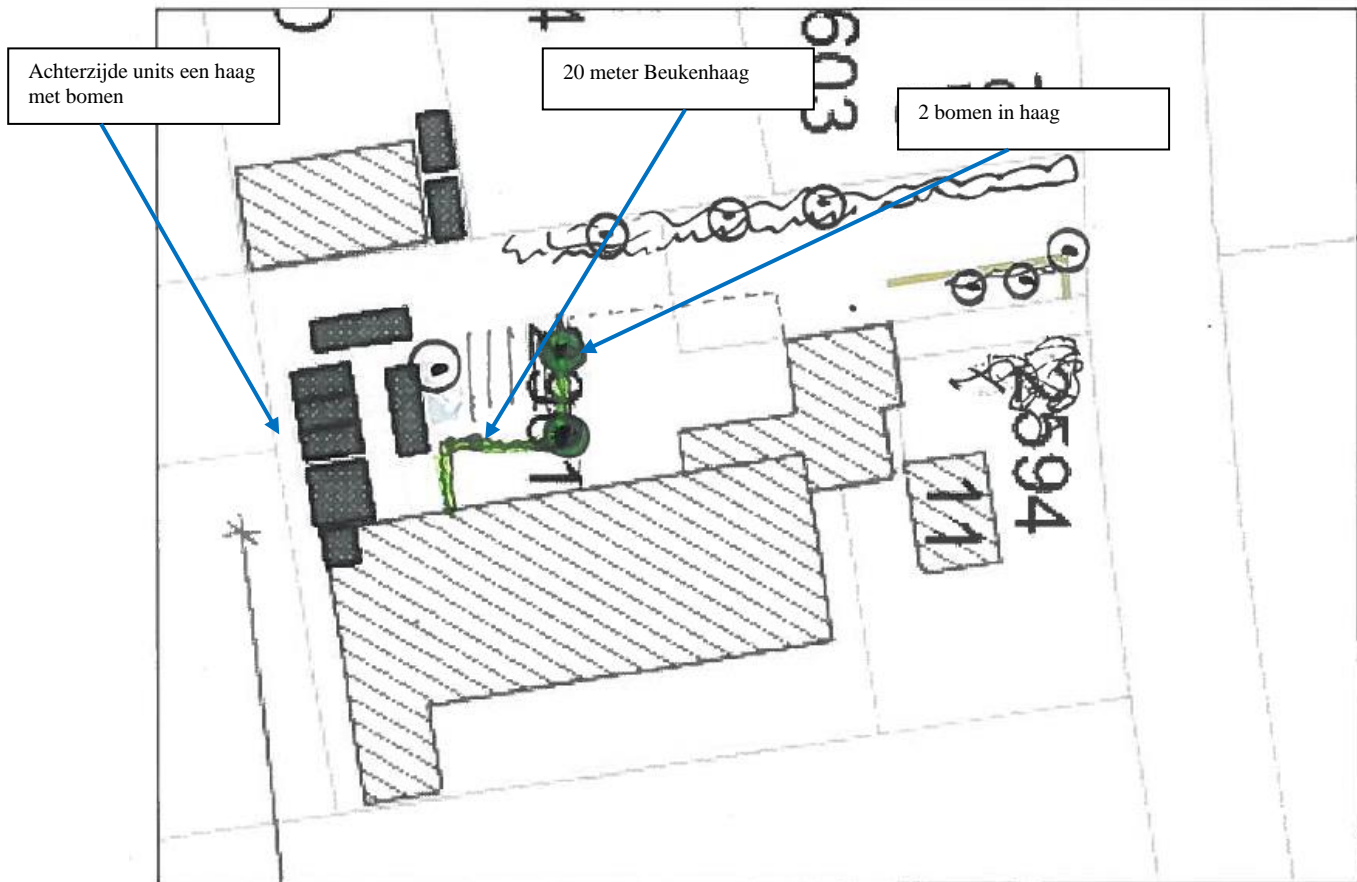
Ingediende landschapsplan, zie ook bovenste foto voorop
